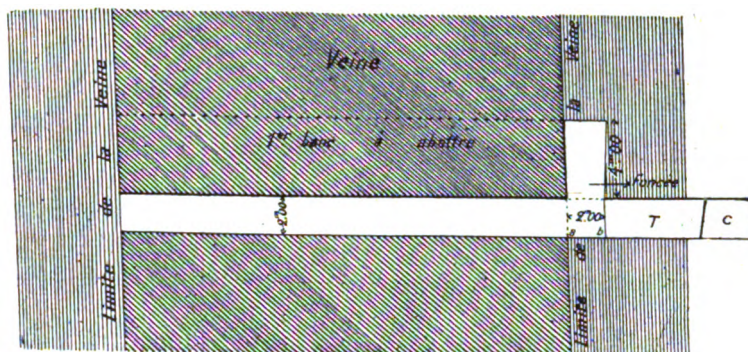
Coupe verticale d'une chambre normalement au fil de pierre pour montrer la foncée du premier banc.
